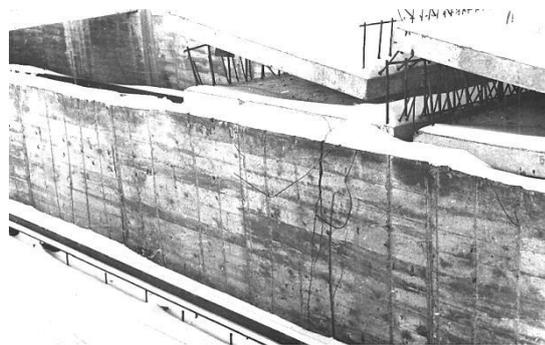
Раскрытие трещин в стенке пропарочной камеры завода керамзитобетонных панелей БСИ ТНХК
